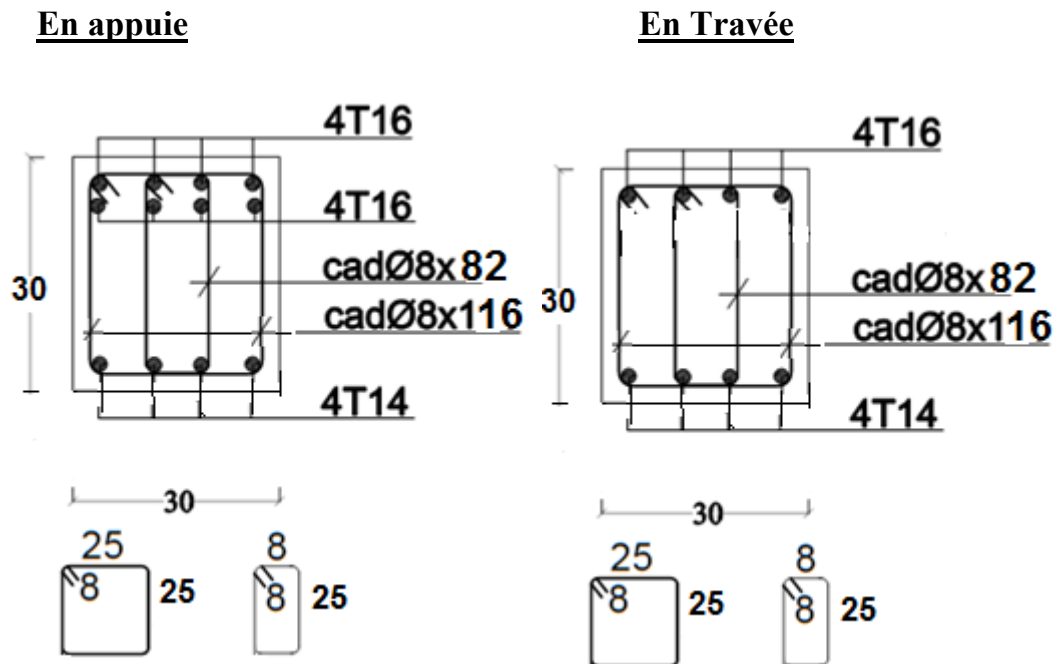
schéma de ferrailage des poutres secondaires.
